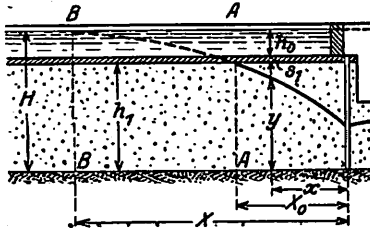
Längserstreckte Anlage unter offenen Gewässern.
